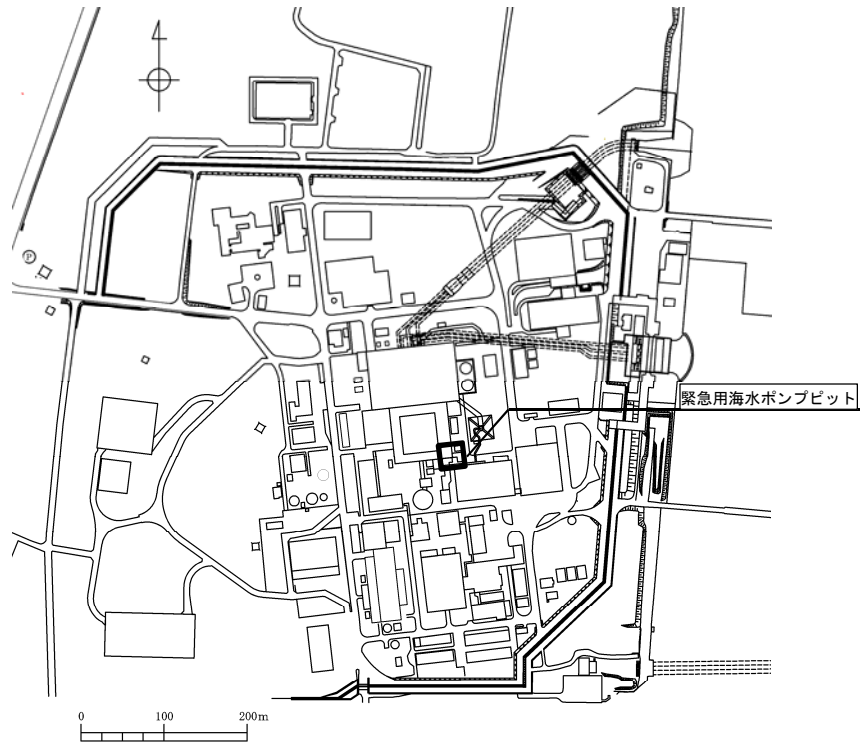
(1) 緊急用海水ポンプピットの平面配置図 (全体平面図)
